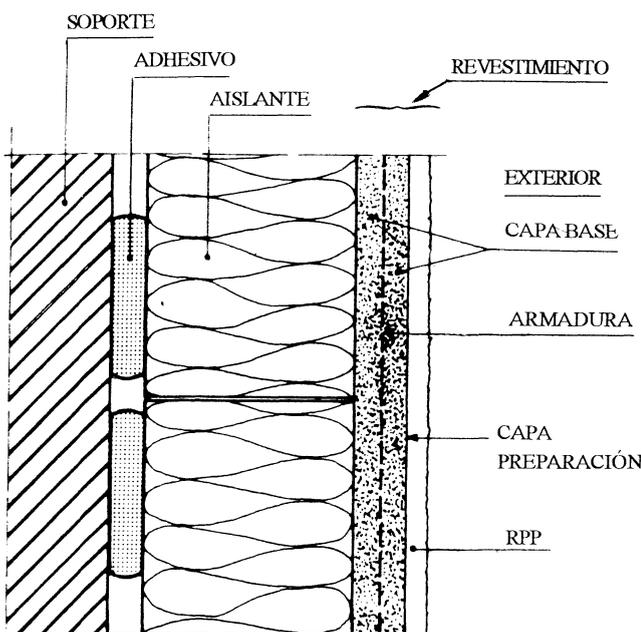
Sistema de aislamiento exterior de fachadas con revestimiento delgado sobre aislante.
